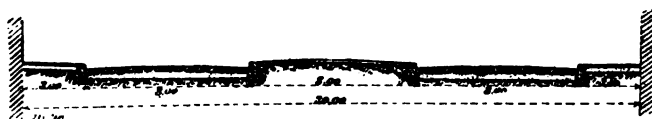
Avenue ou boulevard ayant 2 trottoirs, 2 chaussées et une contre-allée centrale.
